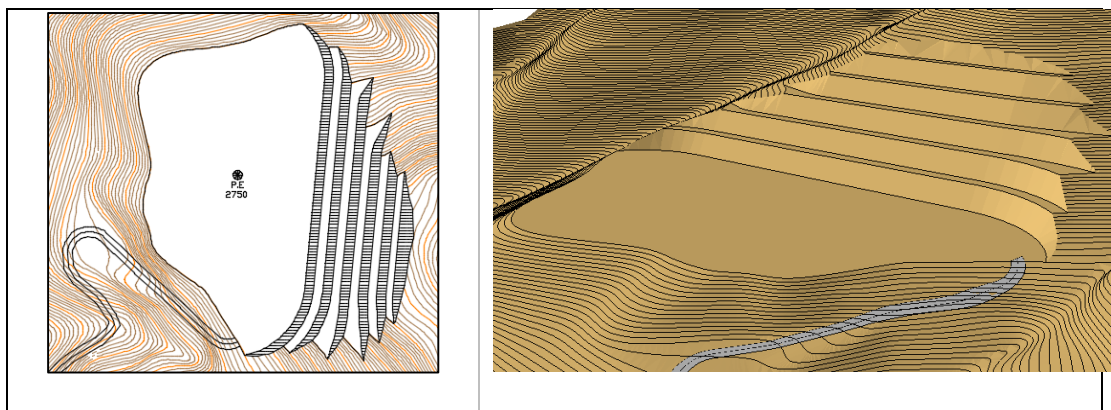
Vista en planta y en 3D de la Fase 6 de explotación.
